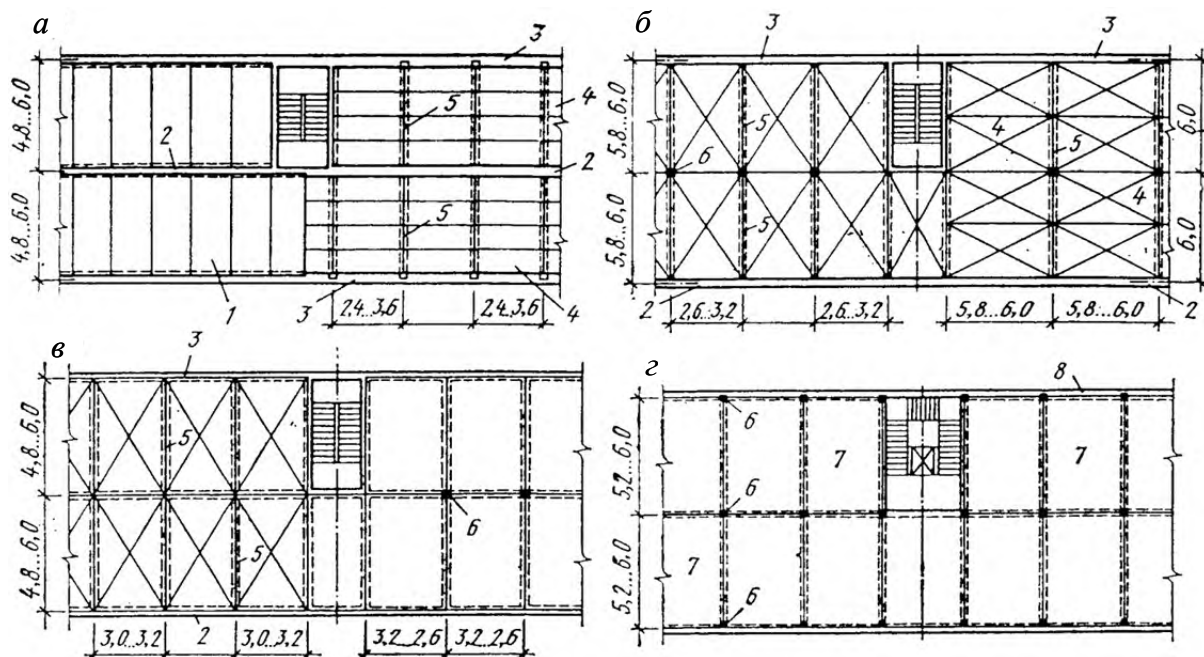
Конструктивные схемы плитных перекрытий:
